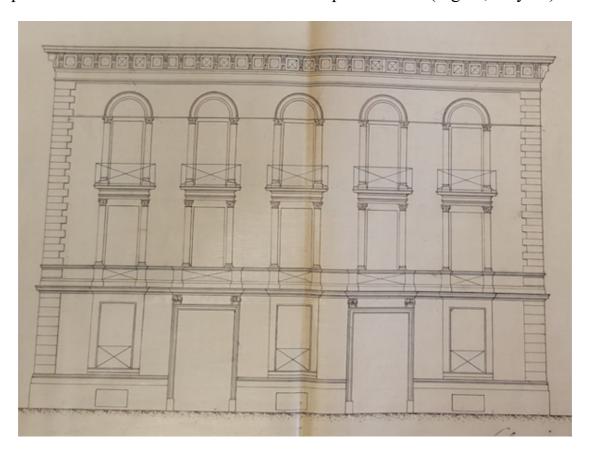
Planos de la fachada. Fuente: Archivo histórico
